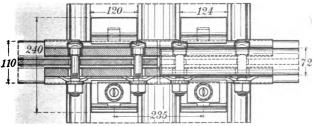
Grundriß und Aufsicht. M. 1:10.
